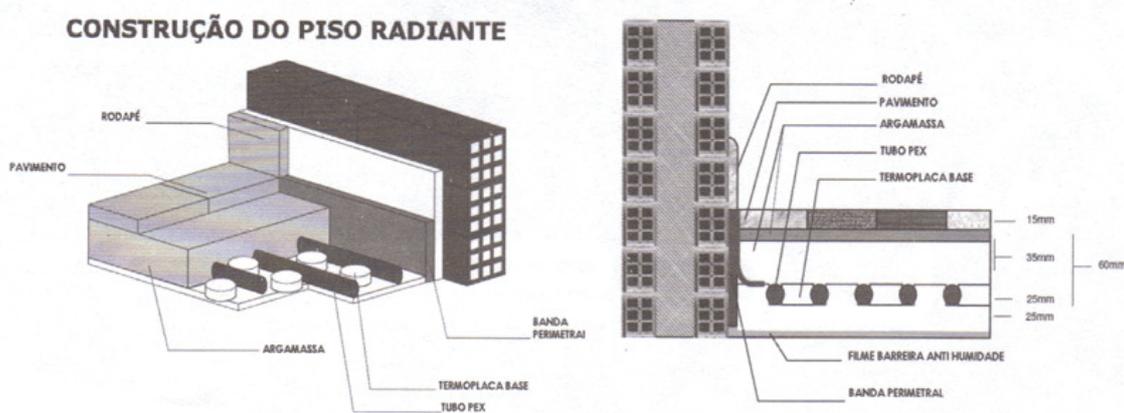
Detalhe de construção do sistema de aquecimento por piso irradiante
